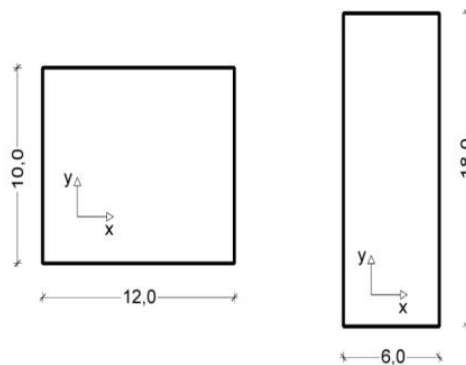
Grundrisse von zwei 2-geschossigen Holzhäusern
